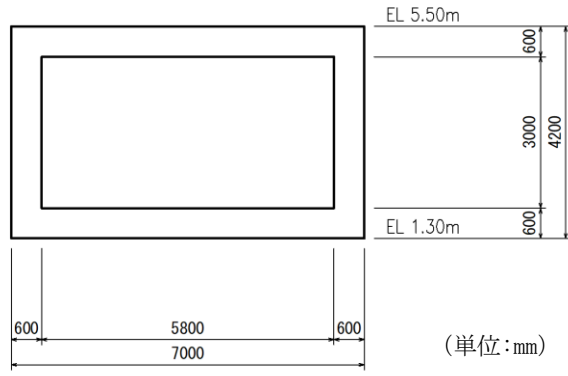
屋外配管ダクト (タービン建物～放水槽) 断面図 (A-A 断面)
